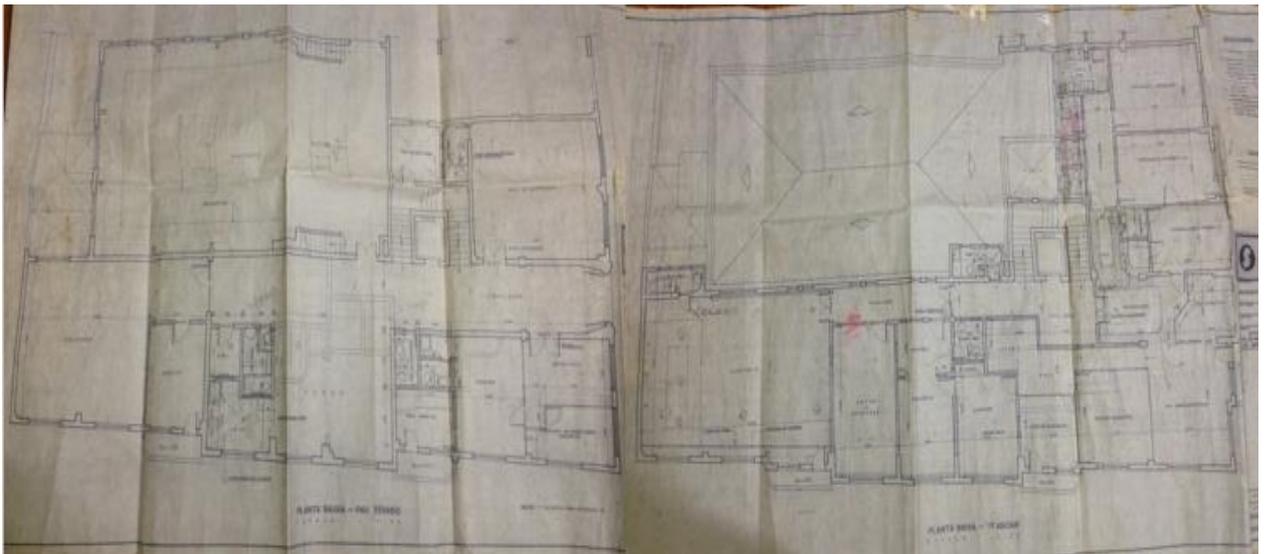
Foto planta baixas do antigo Hotel Central. Fonte: Acervo ACM.
